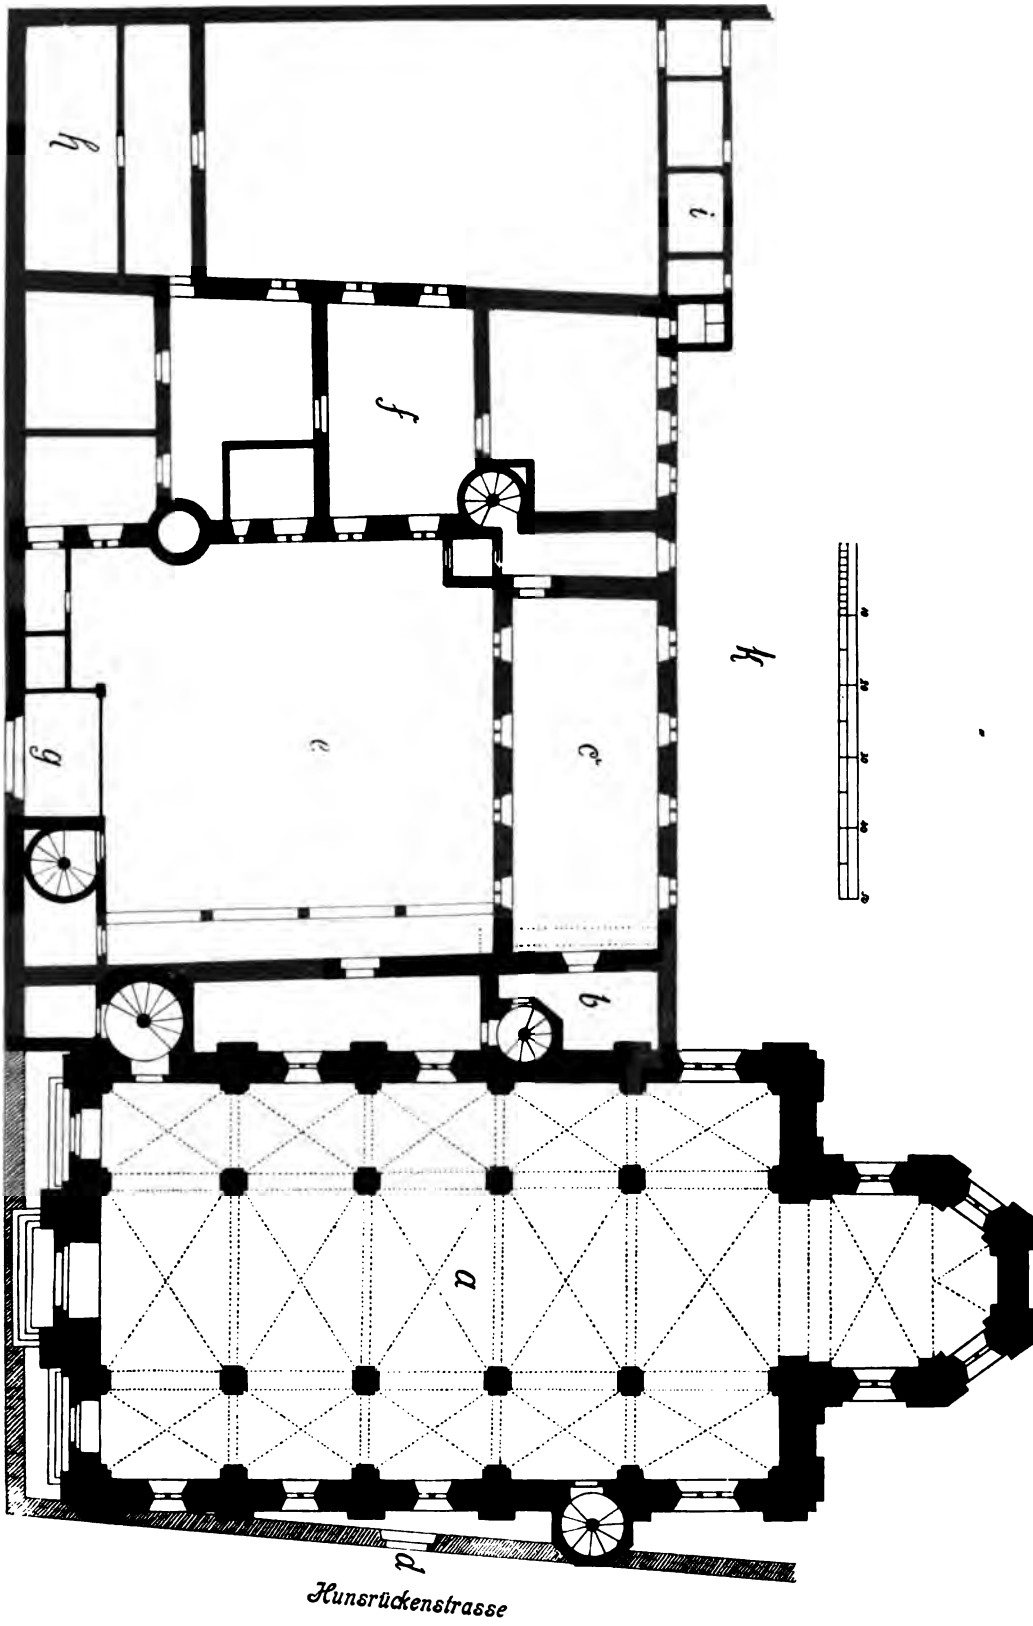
Grundriss des ersten Düsseldorf'er Jesuitenkollegs nebst Plan zur neuen Kirche.
